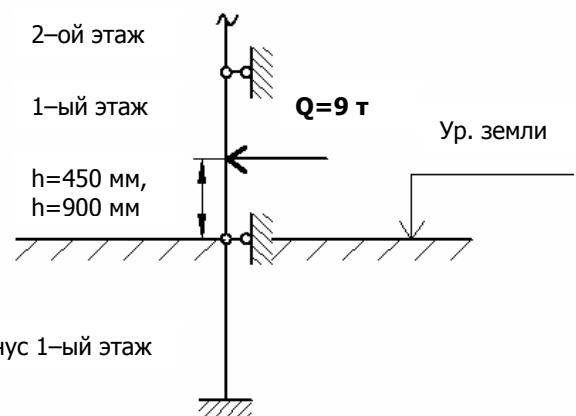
Схема приложения нагрузки на колонны первого этажа
